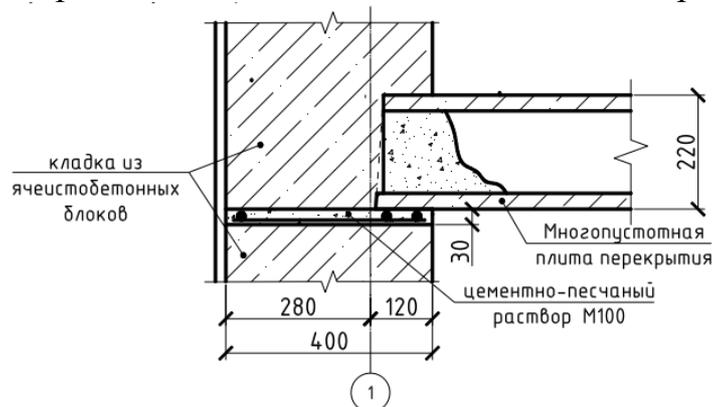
Опираие пустотных плит перекрытий на несущие стены из легкoбетонных блоков
